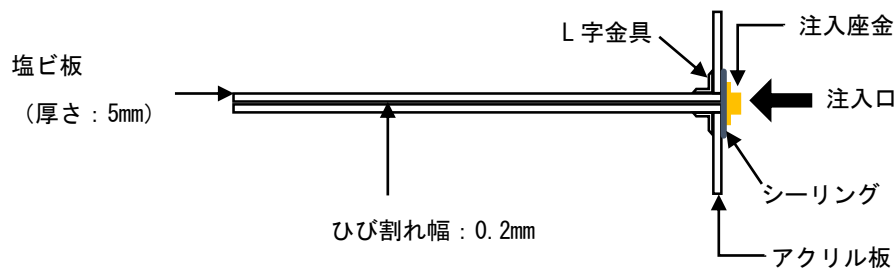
擬似ひび割れ試験体 断面図
